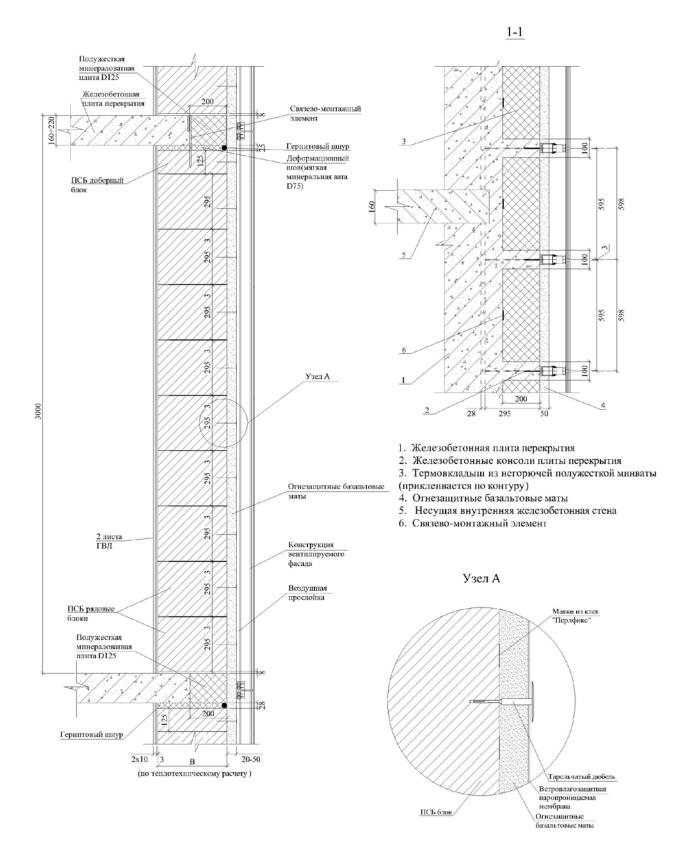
Вертикальный разрез по глухому простенку и горизонтальный разрез по перекрытию
